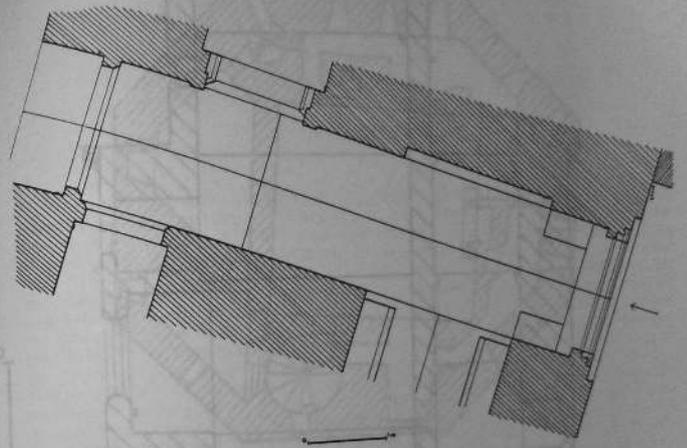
Elven. Donjon. Plan du couloir d'accès (succession des systèmes de fermeture).
